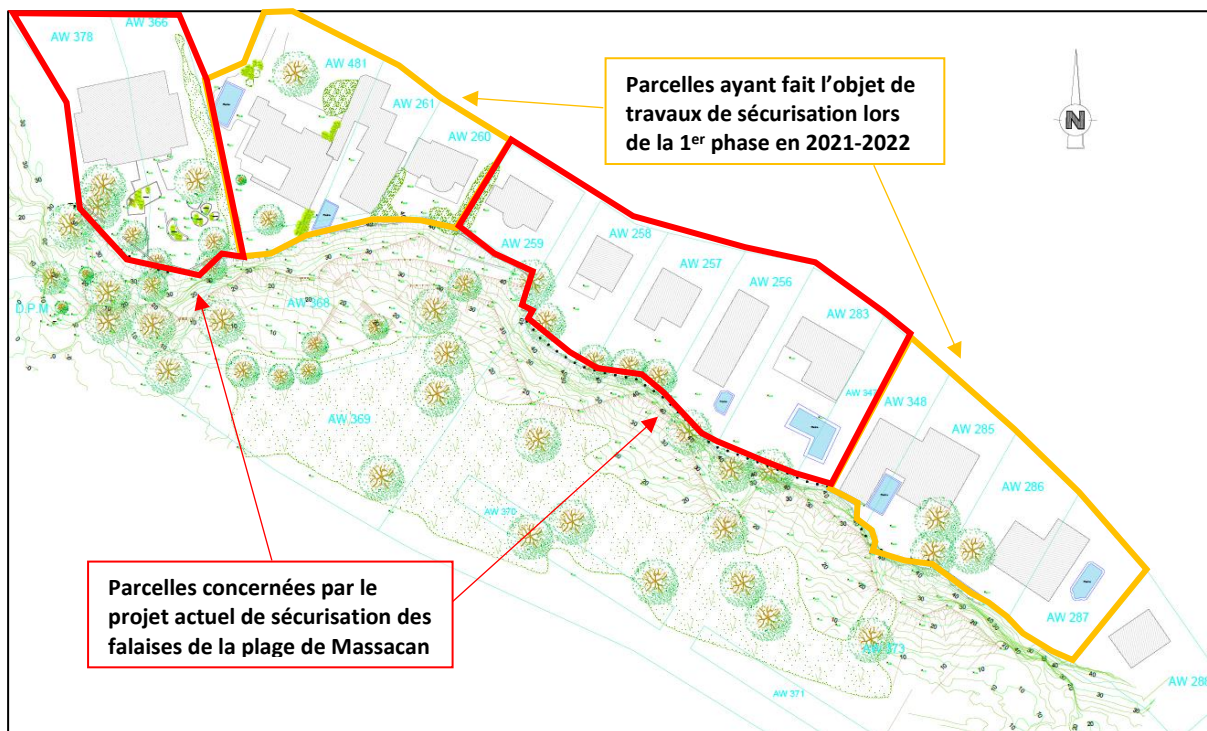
Parcelle à l'étude sur plan de masse du site au 1/200<sup>ème</sup> (échelle non conservée)
